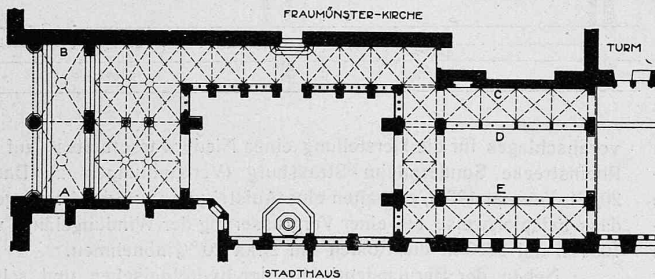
Grundriss des Fraumünster-Durchgangs. — 1:500.
